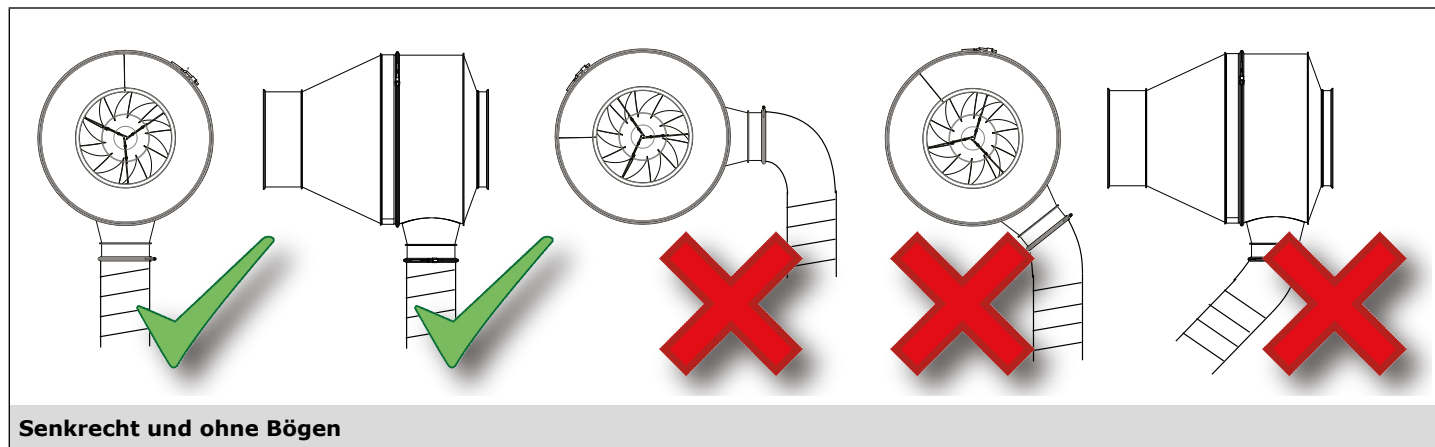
Abb. V Montageanweisungen | Einbau in vorhandenes Rohrleitungssystem
